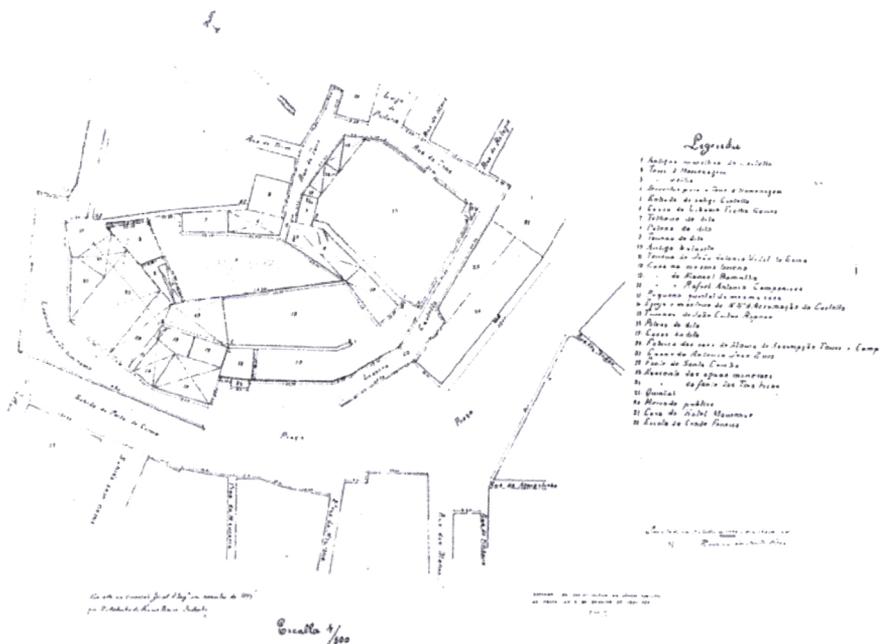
Moura, planta do Castelo de 1883 (CMM)
